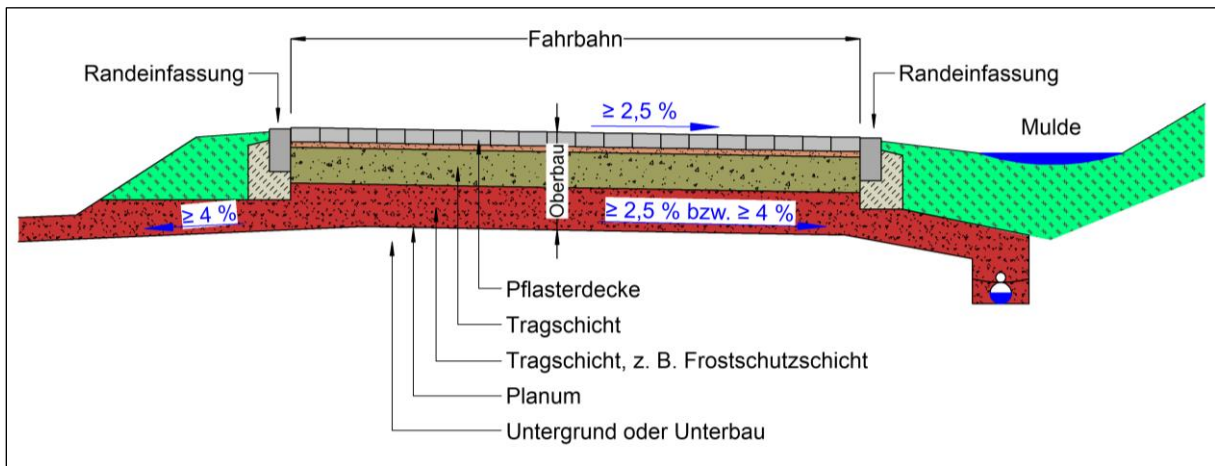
Beispielhafter Aufbau einer Verkehrsflächenbefestigung mit Pflasterdecke außerhalb geschlossener Ortslage in Anlehnung an die RStO (Zeichnung: SLG)
